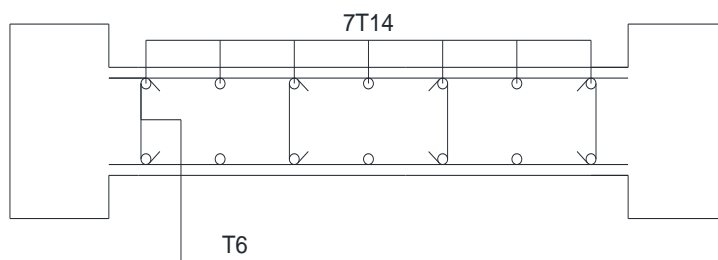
Schéma de ferrailage du voile (poutres normales - plan régulier)
